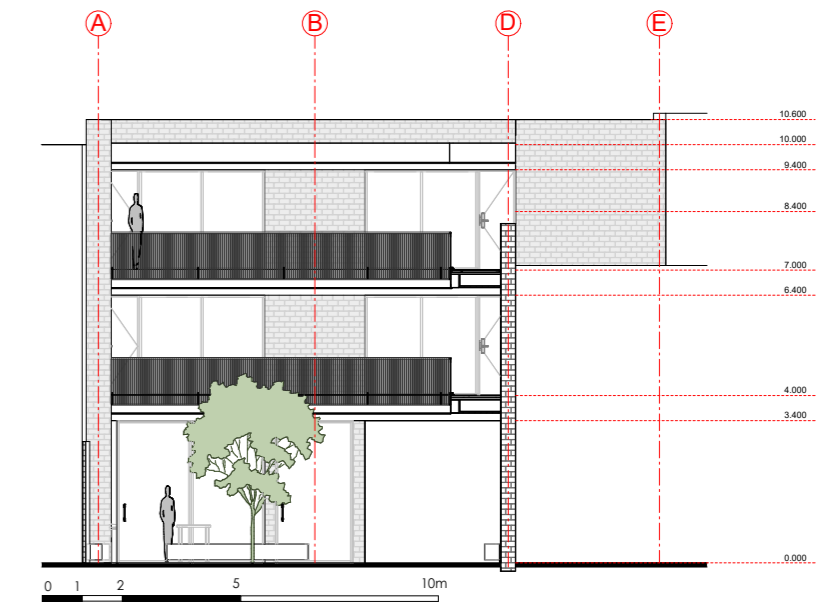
Alzado este bloque central (BC-02). Fuente: Elaboración propia.
